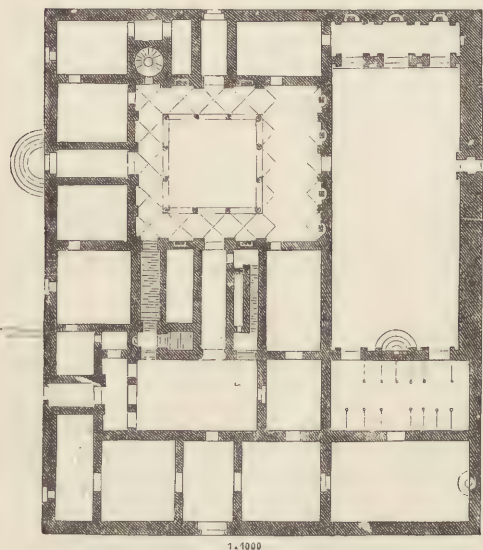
Pal. Riccardi zu Florenz. Grundriss.
